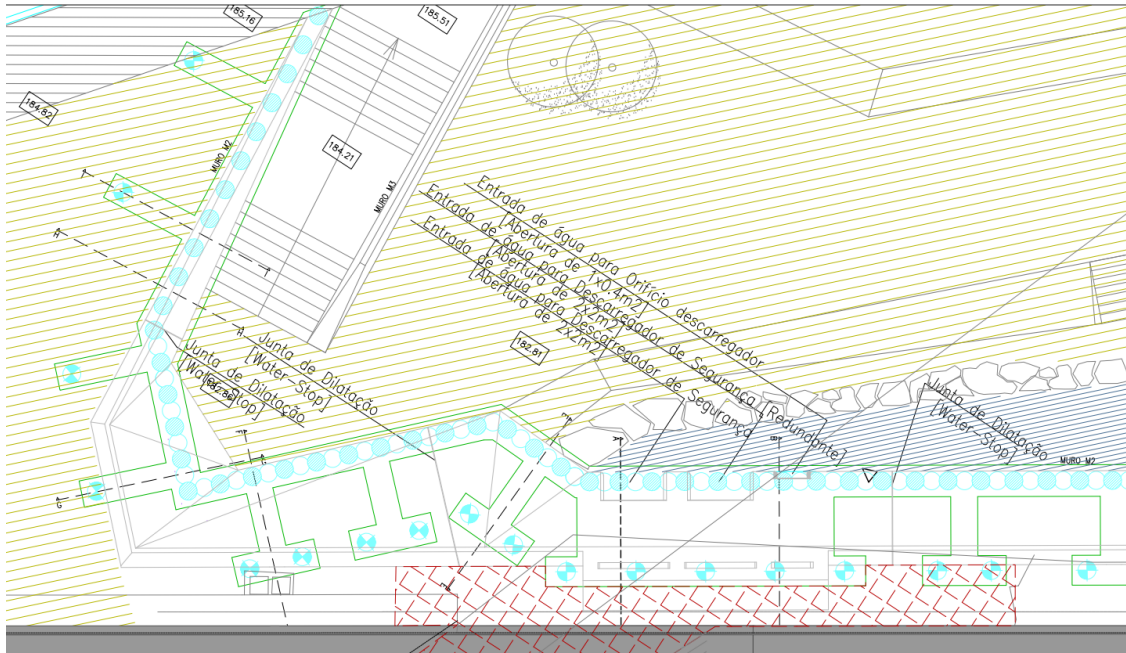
Plano de Fundações. Estrutura de retenção a Montante. Fonte: Projegui.
